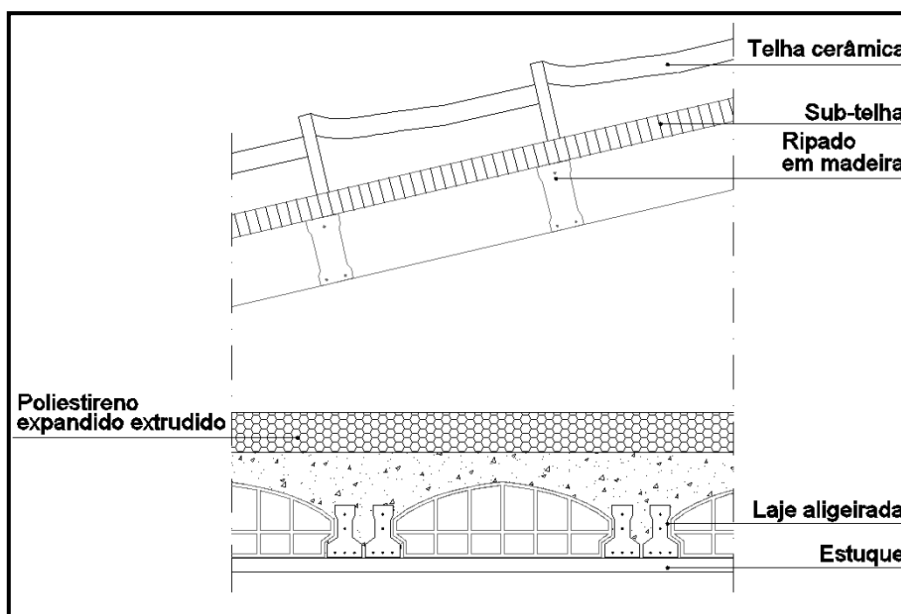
Pormenor da cobertura inclinada com laje horizontal, em corte (LAJ01 e LAJ02)
